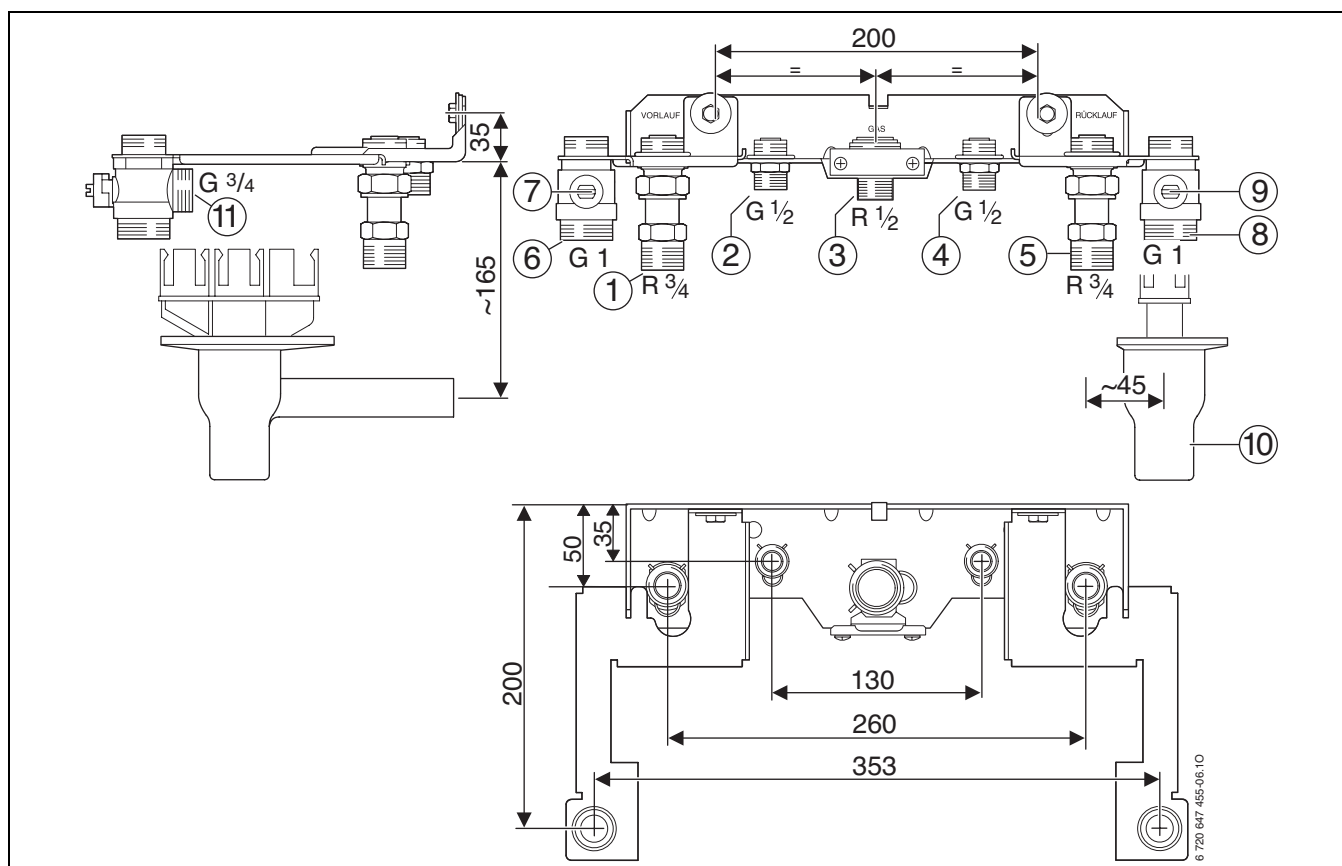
Esempio: piastra di collegamento per il montaggio U-MA con la prolunga per il collegamento dell'accumulatore inerziale e set di collegamento AS6-AP
